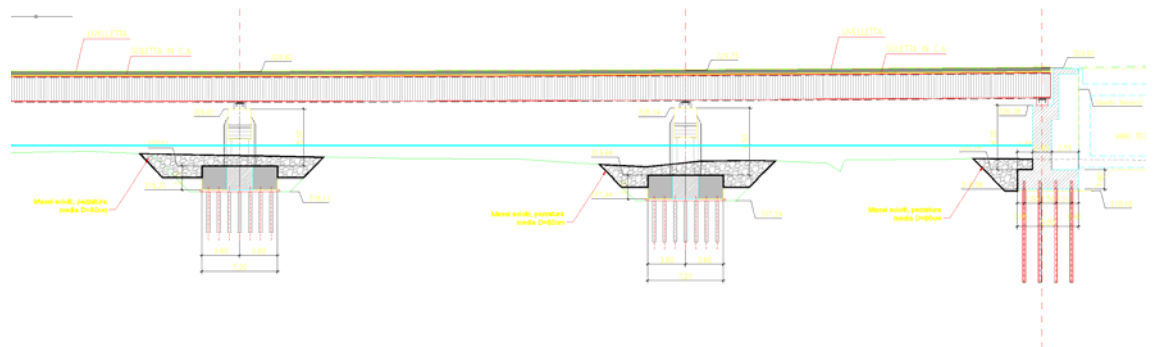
Viadotto Settecà protezione pile 2 e 1 e spalla Sud, viadotto Sud
